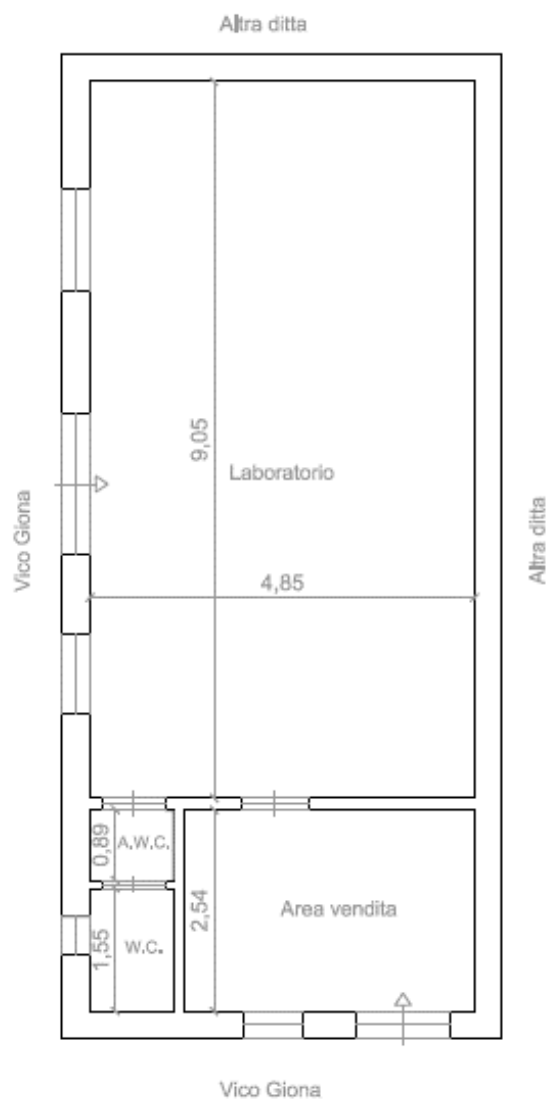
Planimetria del subalterno 1 (piano terra), con individuazione dei locali
